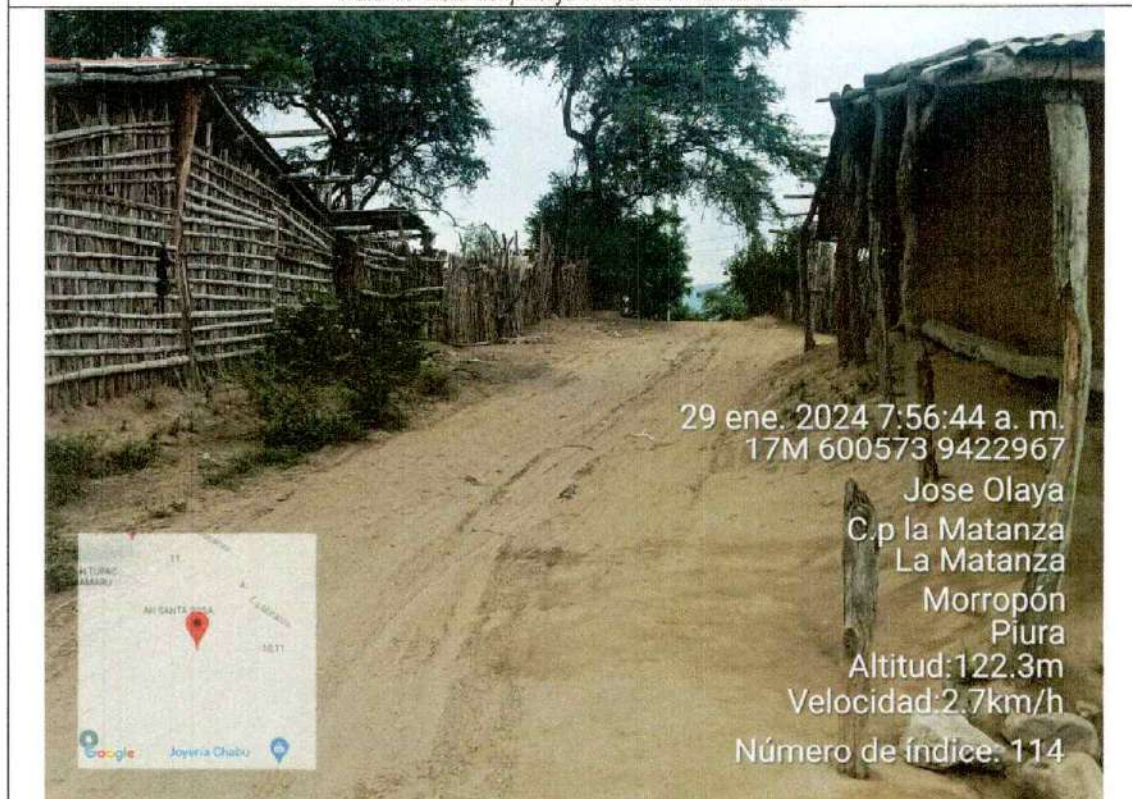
Vista del pasaje 2 del A.H. Santa Rosa
